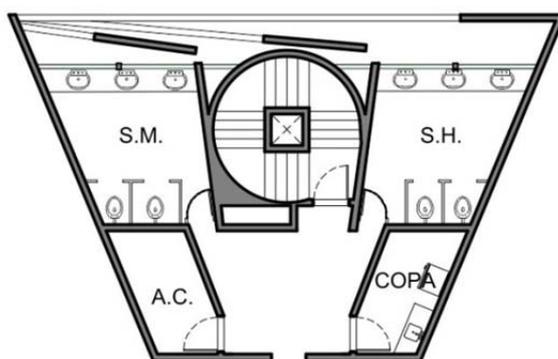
Planta do setor de infraestrutura do pav.tipo da sede do Banco Safra – segunda opção
